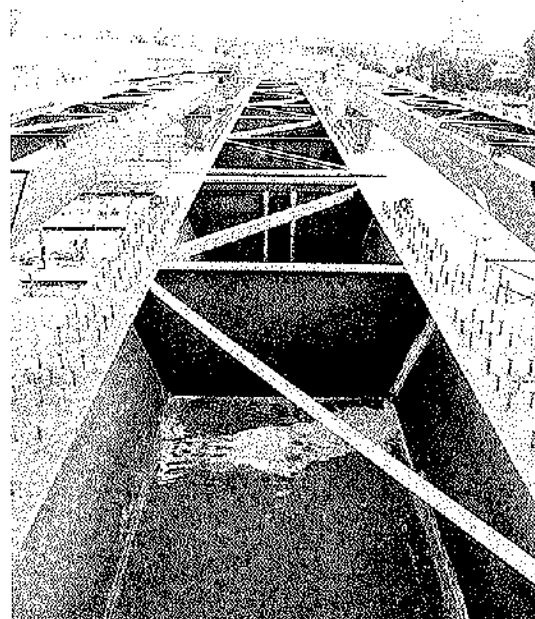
Vista de las vigas metálicas ya montadas, antes de colocar las losas.
